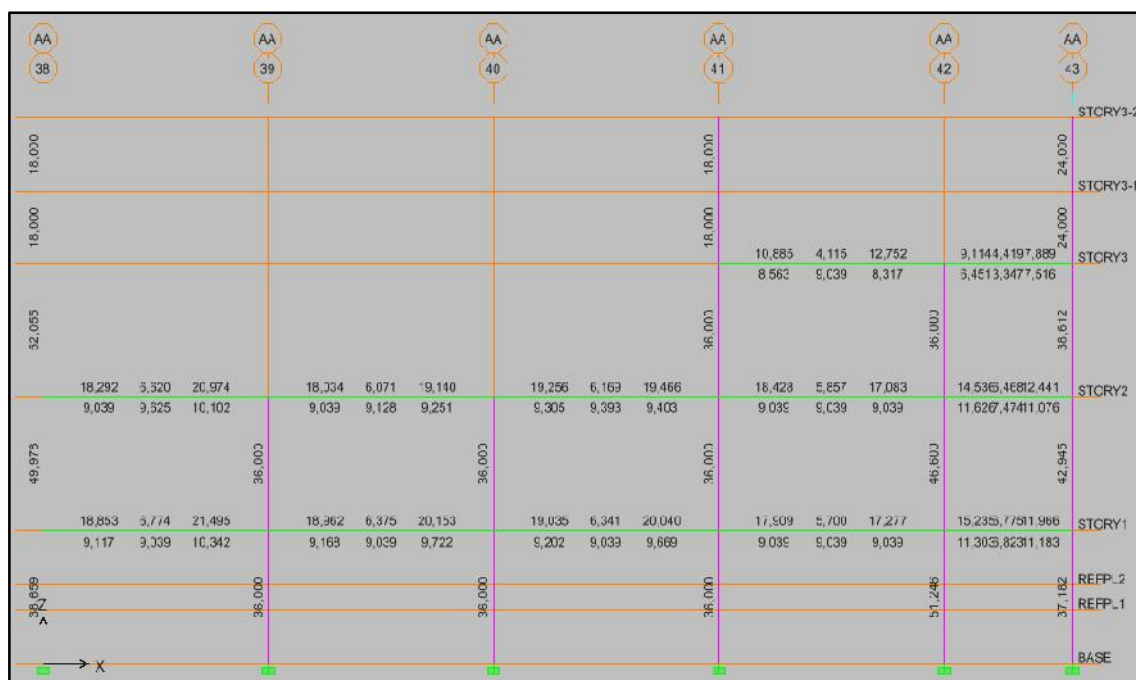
Acero en vigas pórtico AA, Consulta Externa II
